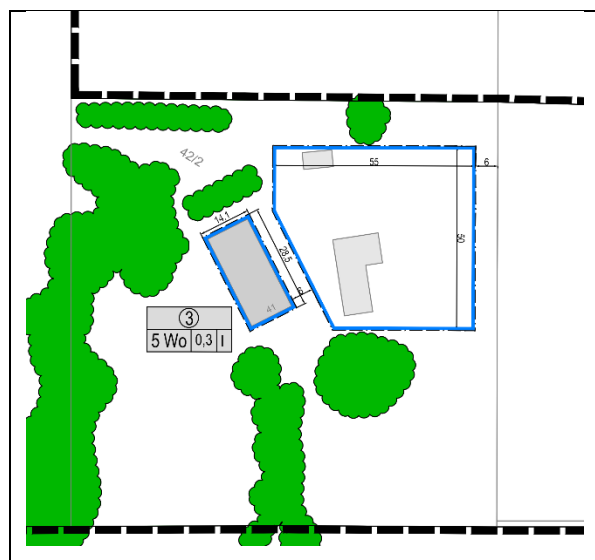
Hausnummer 41 - Lageplan (o.M.)
